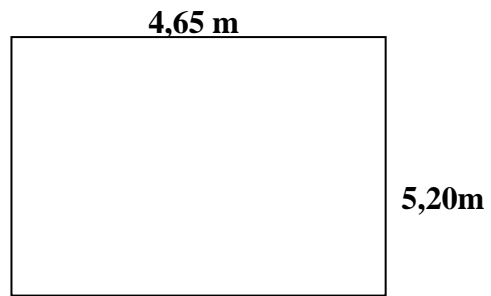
La section du plus grand panneau de la rampe d'accès.
